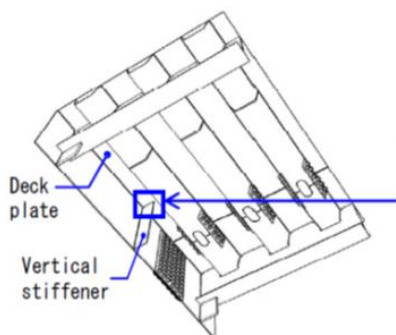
Монтажно снаждане при стоманен мост по АМ Хемус на km 26+884
